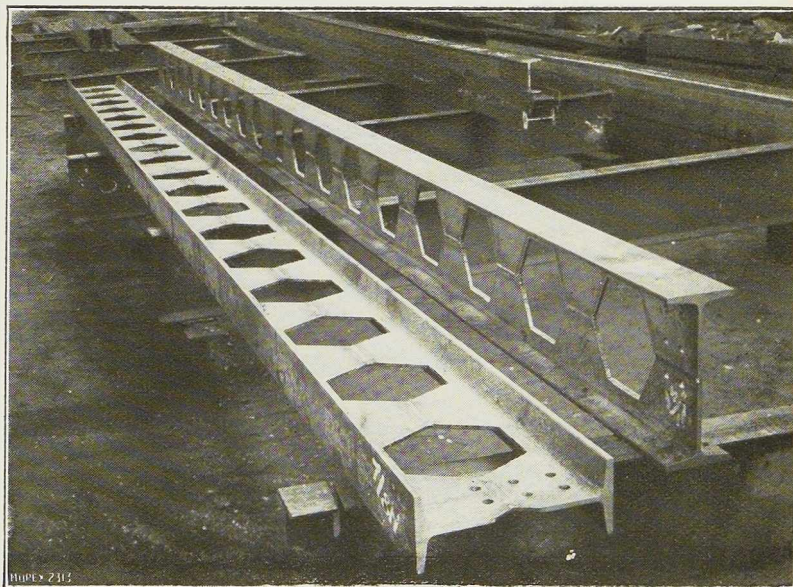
Poutres métalliques évidées construites par soudure.
